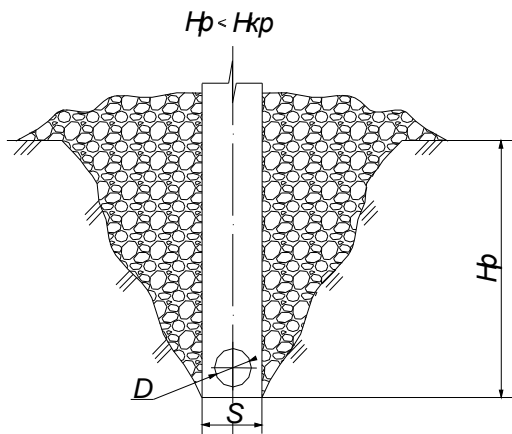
Характер разрушения грунта при укладке газопроводов диаметром более 150-200 мм
